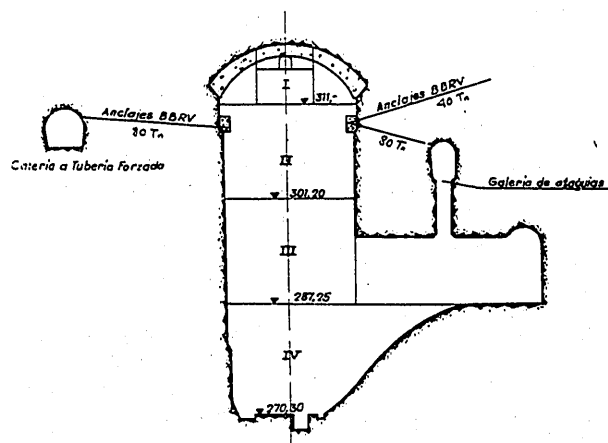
Disposición de los cables de gran tensión, para arriostrado de las vigas del puente-grúa.
